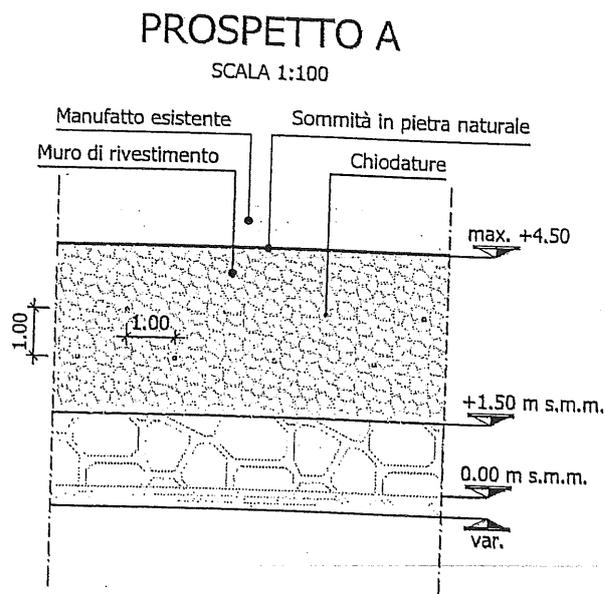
Vista frontale del paramento verticale di protezione del muro.
